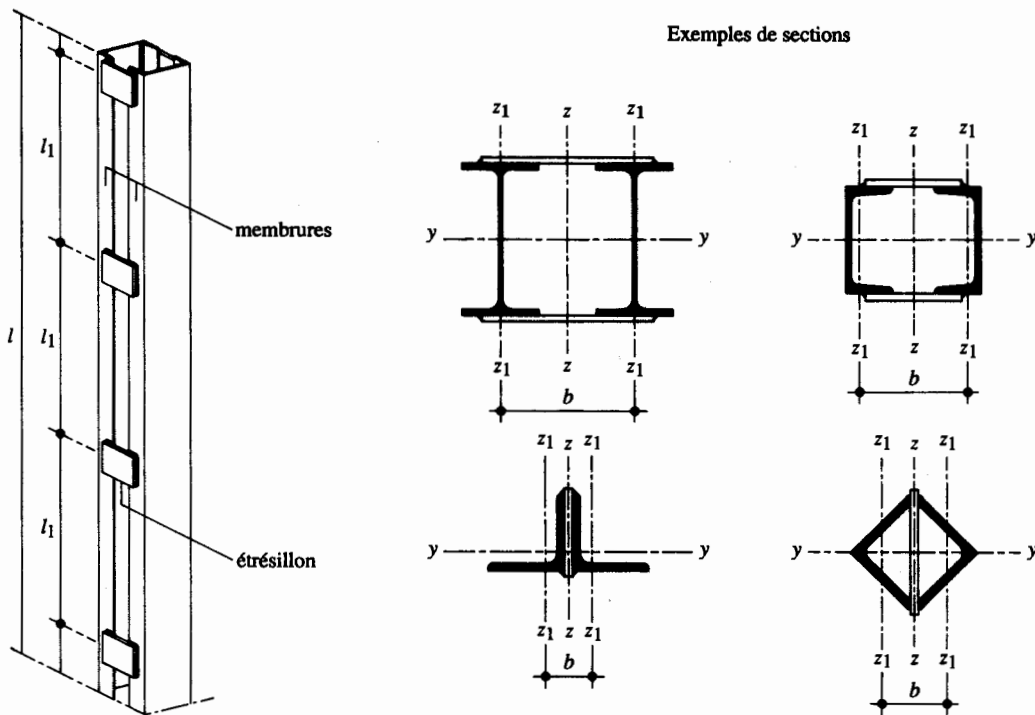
Principe d'une barre étré sillonnée et exemples de sections.
